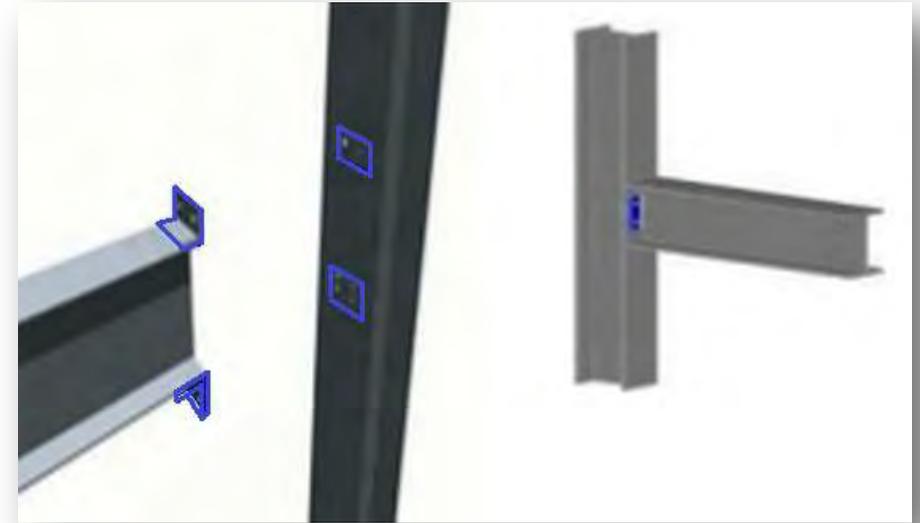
Unión soldada de viga y columna metálica. Fuente Web: <http://es.slideshare.net/william0388/uniones-y-conexiones-en-estructuras-de-acero> (Acceso Mayo 14 del 2015).
